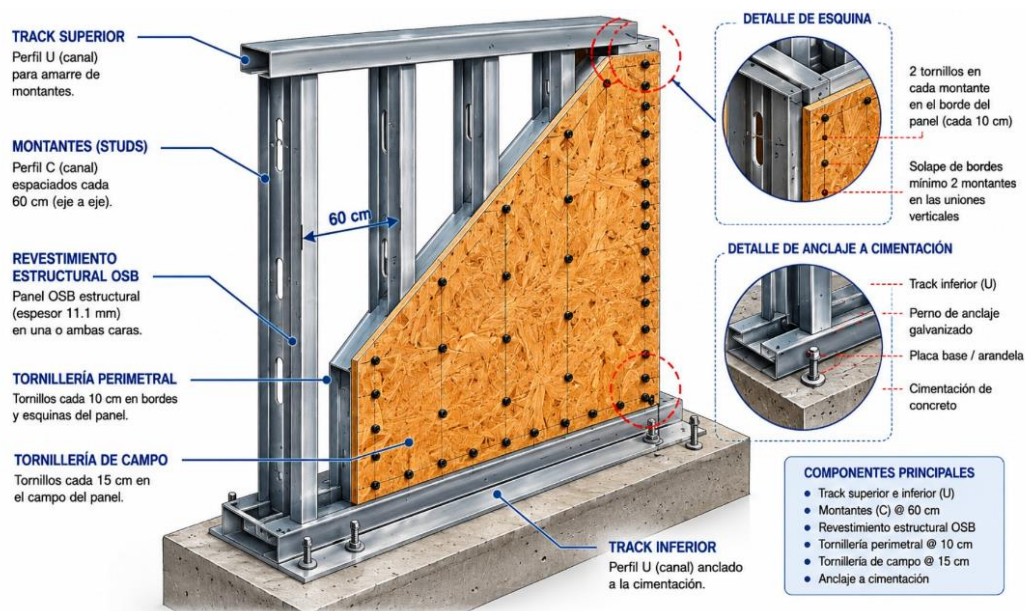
Ensamblaje típico de un muro portante en sistema Steel Framing (vista isométrica parcial). Fuente: Propia.
